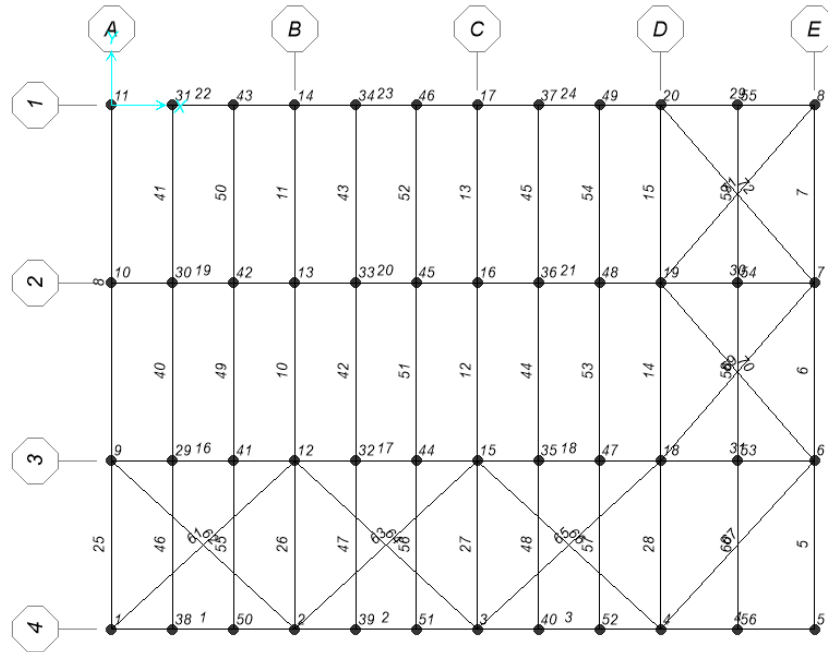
Vista in pianta modello struttura in elevazione – Piano 1 $z = 5,5$ - numerazione elementi frame e joint
